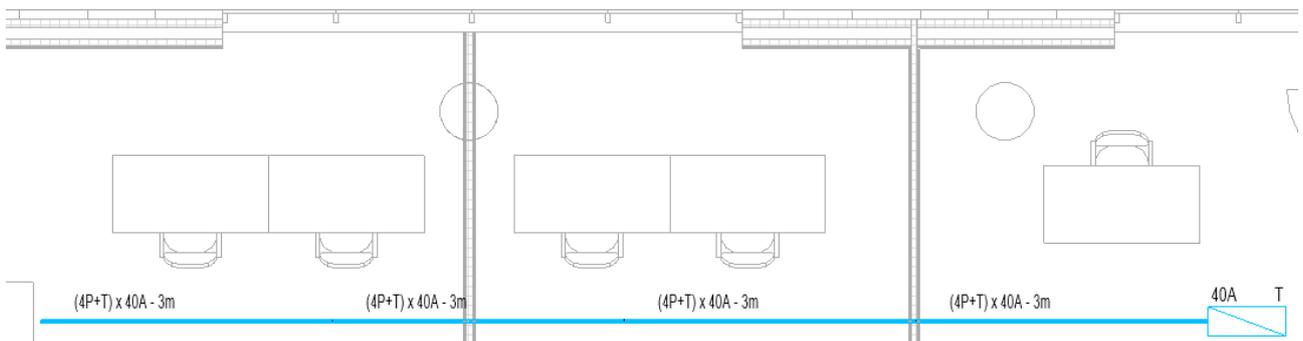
Condotto sbarre a dettaglio Basso in pianta
